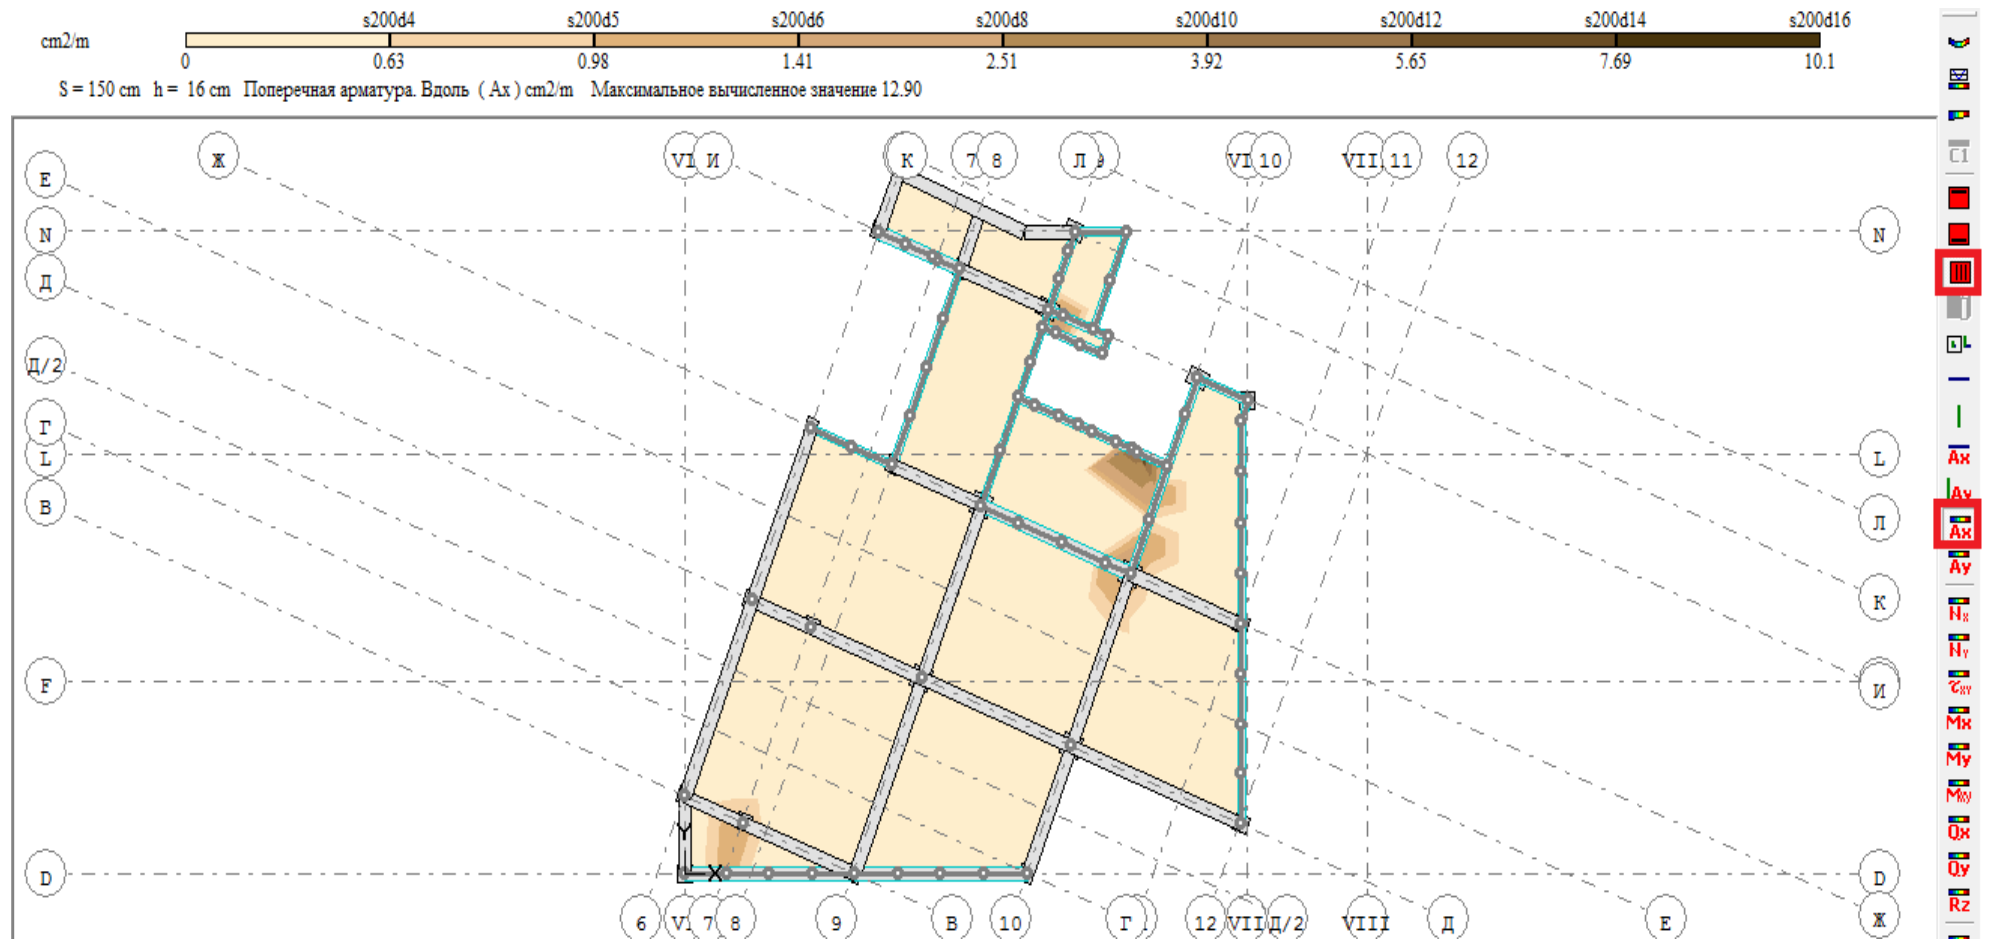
Плита перекрытия на первом поверсі. Розподіл робочої поперечної арматури по нижній грані плити у напрямку вісі OX
